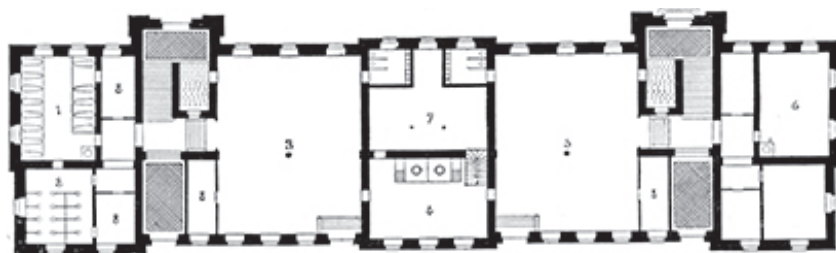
Plan du sous-sol. Echelle : 1/500.
